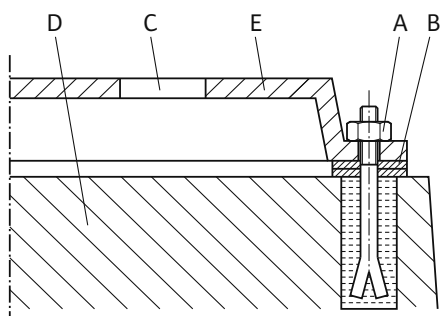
Voorbeeld voor een fundament-draadaansluiting
